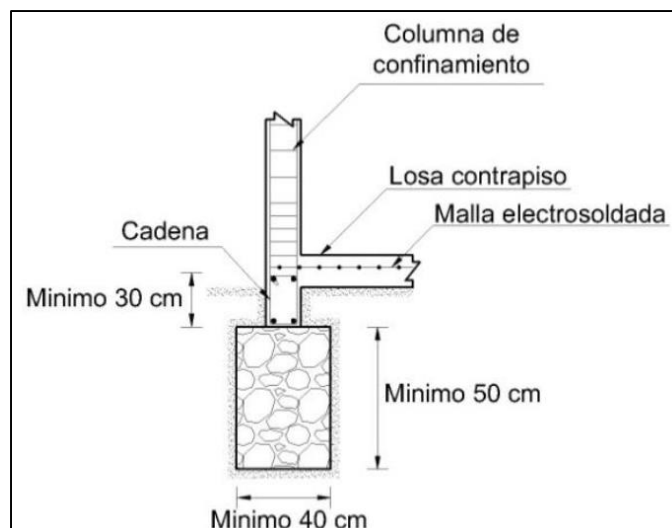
Tipo de cimentación en muro portante, Cadena de cimentación sobre zócalo de hormigón ciclópeo. Tomado de (CPE-INEN-NEC-SE-VIVIENDA, 2015).
